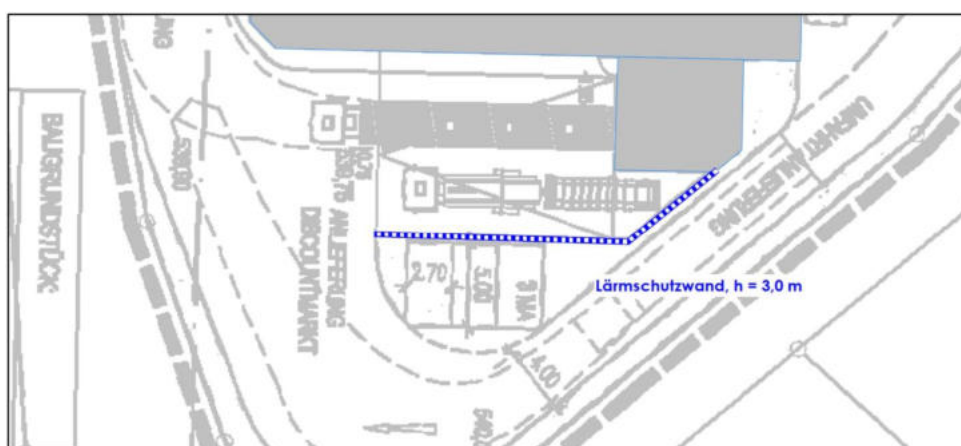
Lageplan mit Eintragung der Lärmschutzwand
